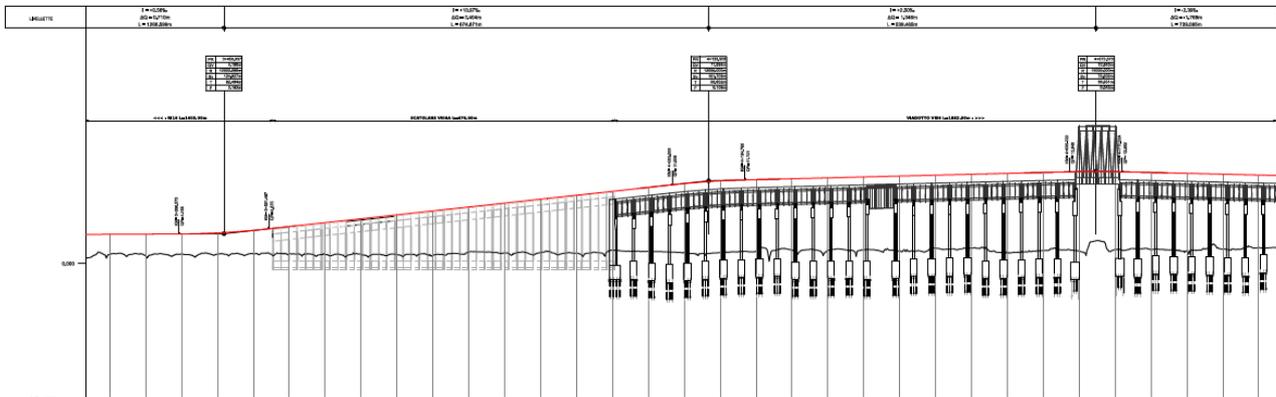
Stralcio del profilo longitudinale (km 3+250 - km 4+900)
